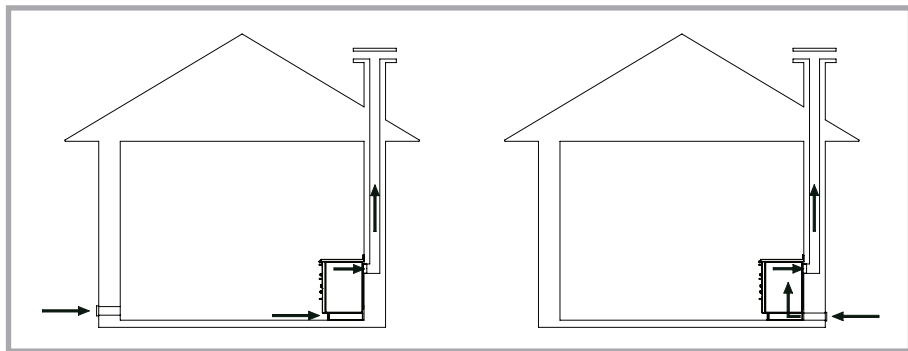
Installazione mediante presa d'aria nel locale e installazione con presa d'aria esterna collegata direttamente alla cucina a legna.
